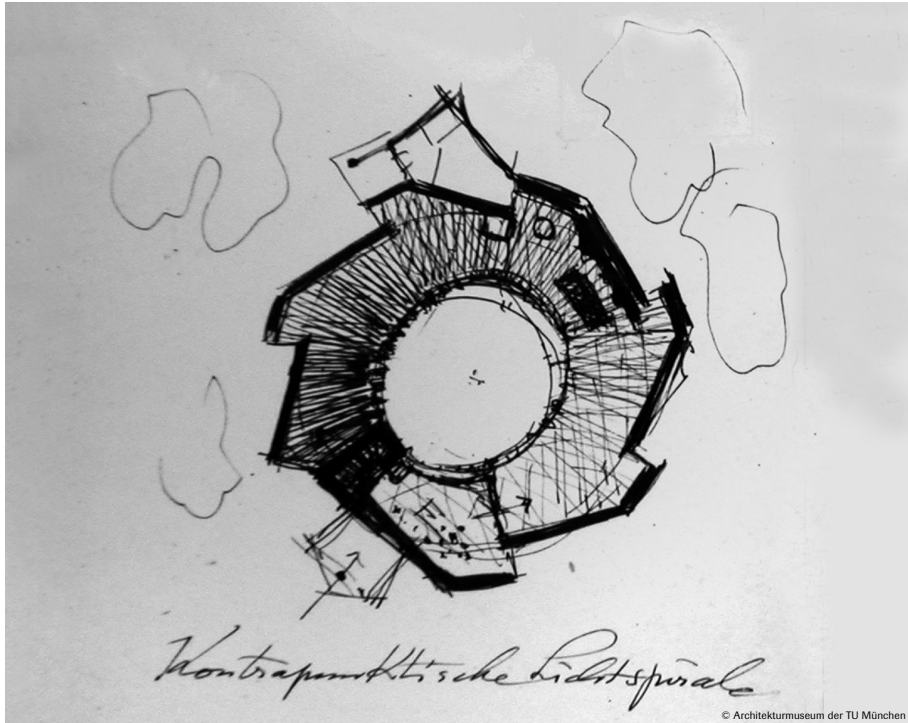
»Kontrapunktische Lichtspirale«, Grundrisskizze Decke, Adolf Abel, 1950.
